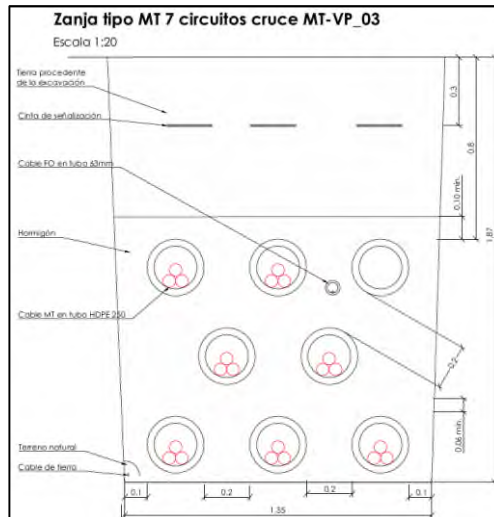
Sección tipo de la zanja para cruces de MT entre las islas 08 y 07 con Vía Pecuaría
